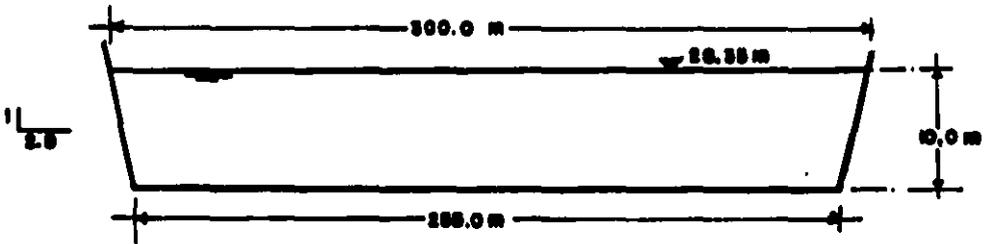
Sección transversal promedio, excavado en el estrechamiento estimado, con  $Q = 4.250 \text{ m}^3/\text{seg.}$  (paso 2 del primer tanteo).
